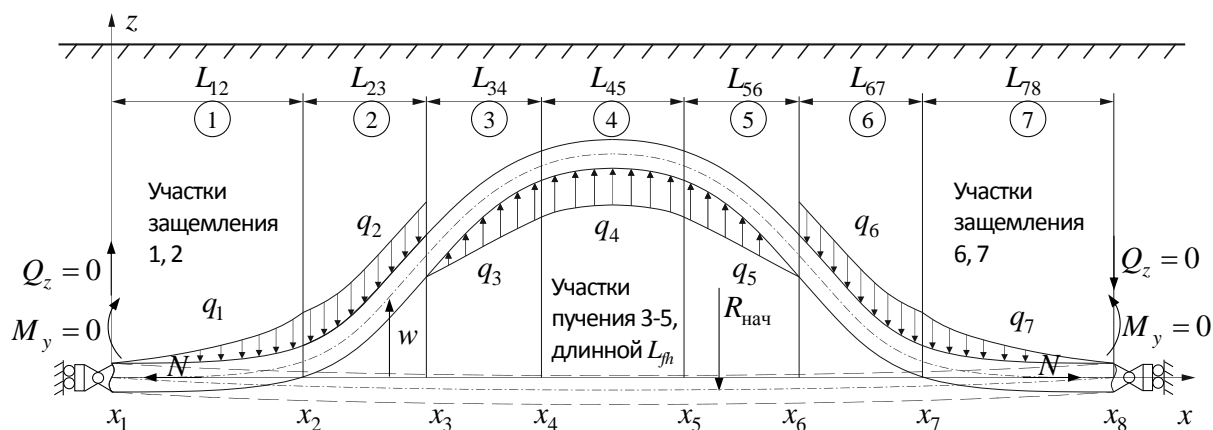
Расчётная схема и граничные условия для определения НДС трубопровода при пересечении участка пучинистого грунта
